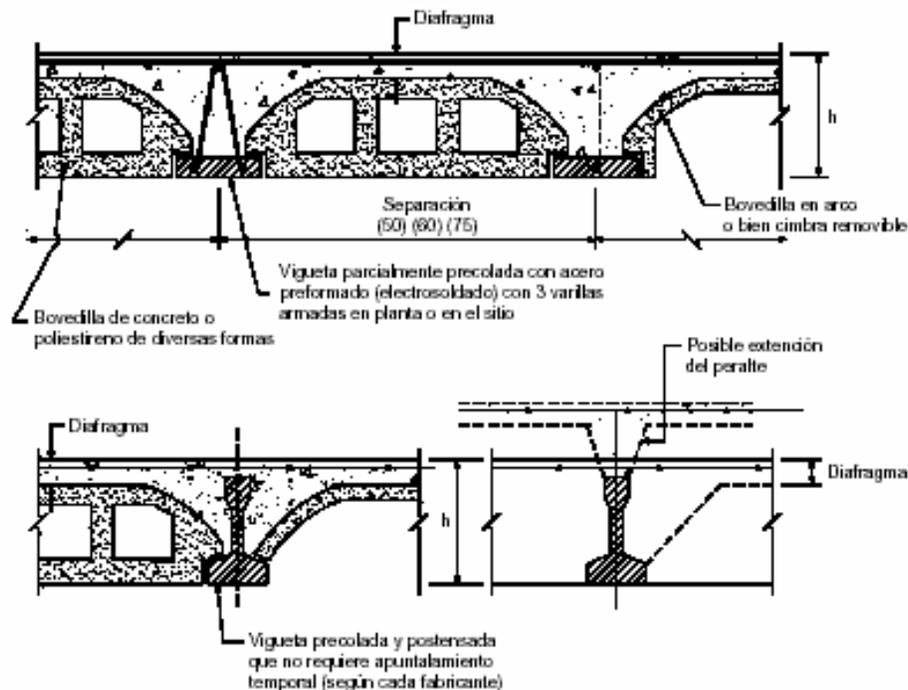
Figura S.P.A. a) Detalles en sistemas de piso prefabricados.
